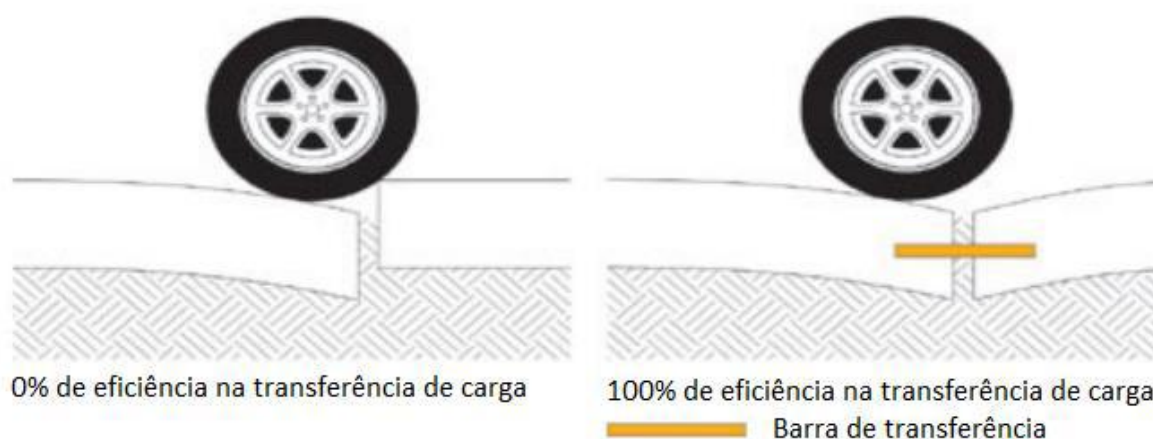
Desnivelamento entre placas de concreto do pavimento rígido sem e com barras de transferência.
